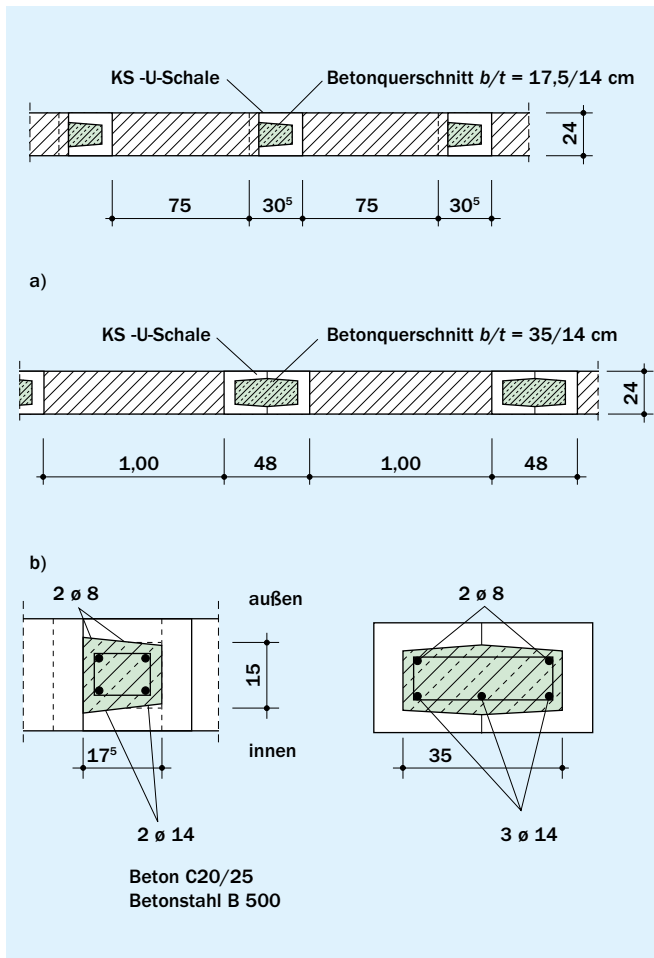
Aussteifende Stahlbetonstützen unter Verwendung von KS-U-Schalen
